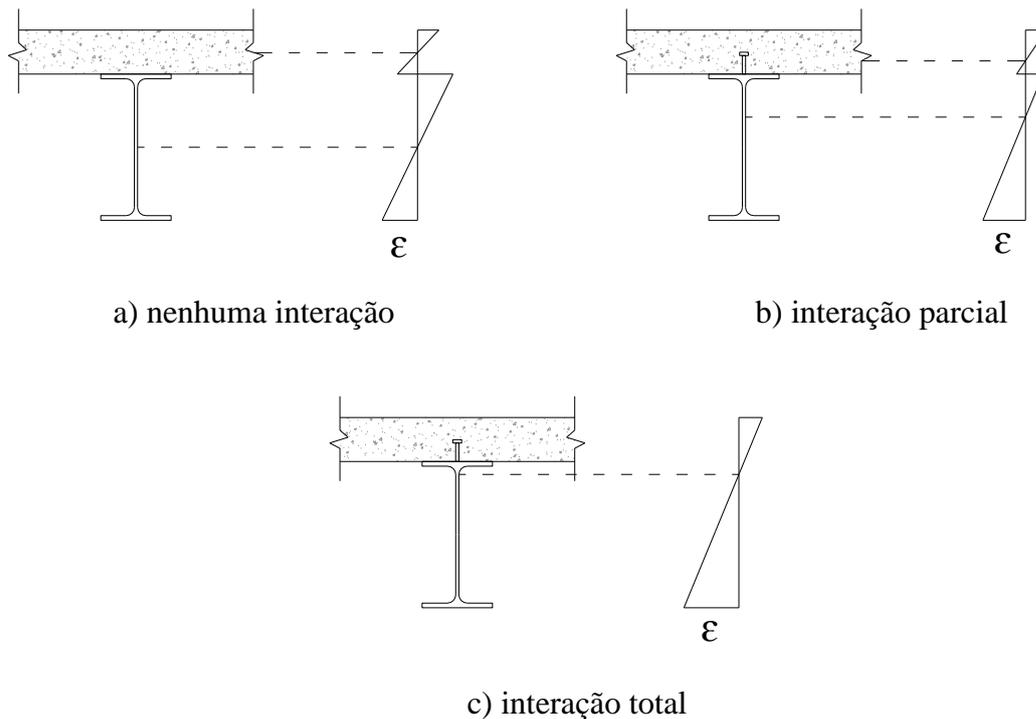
Interação aço-concreto em vigas mistas, David (2007).
